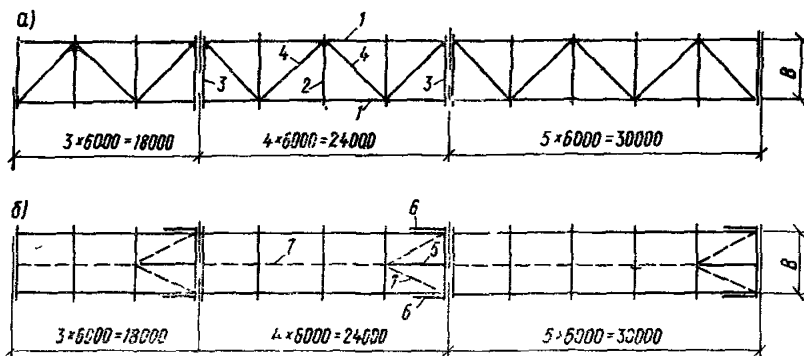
План балок, тяжей и связей покрытия галерей (с расположением транспортера по низу ферм) с применением сборных железобетонных плит длиной 6 м
